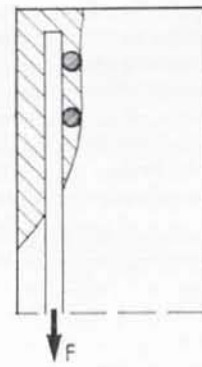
Beispiel für das Abplatzen der Betondeckung bei Verankerung von Bügeln durch angeschweißte Stäbe
